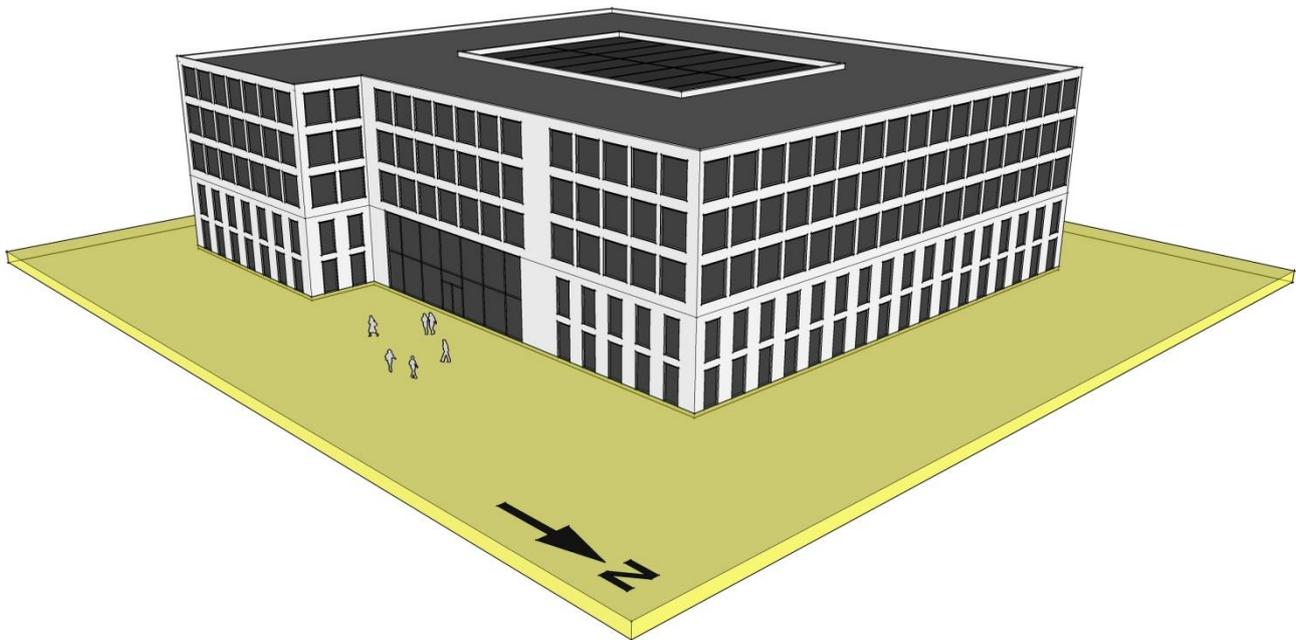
Büros - Module - Atrium - Darstellung Gebäude - Ansicht Nord-Ost
